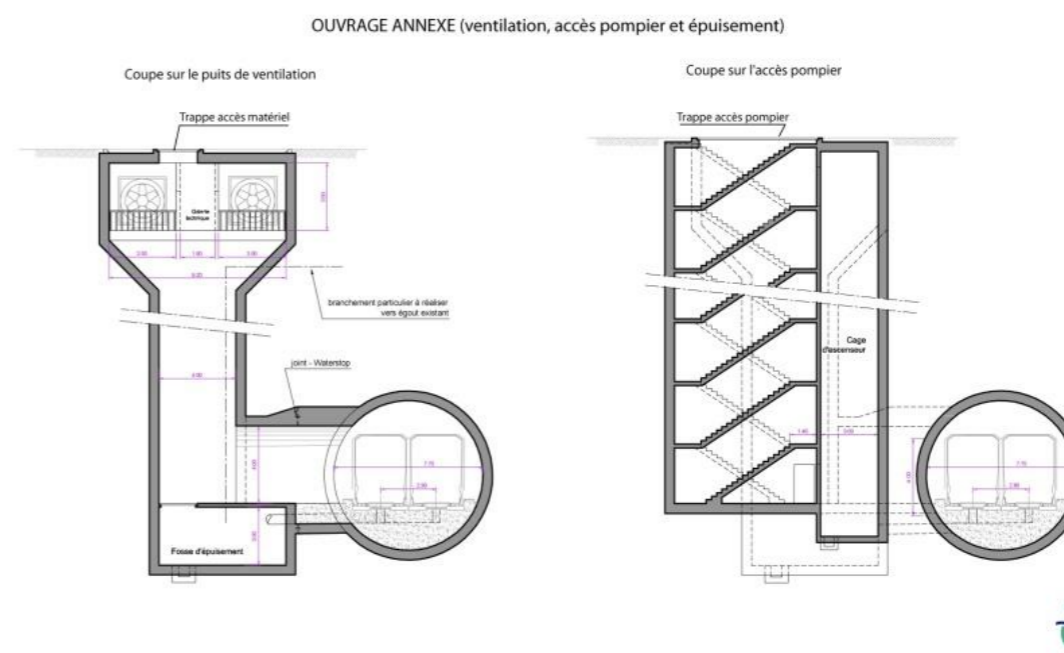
Coupes des ouvrages puits de ventilation et accès pompiers (Source : RATP)
